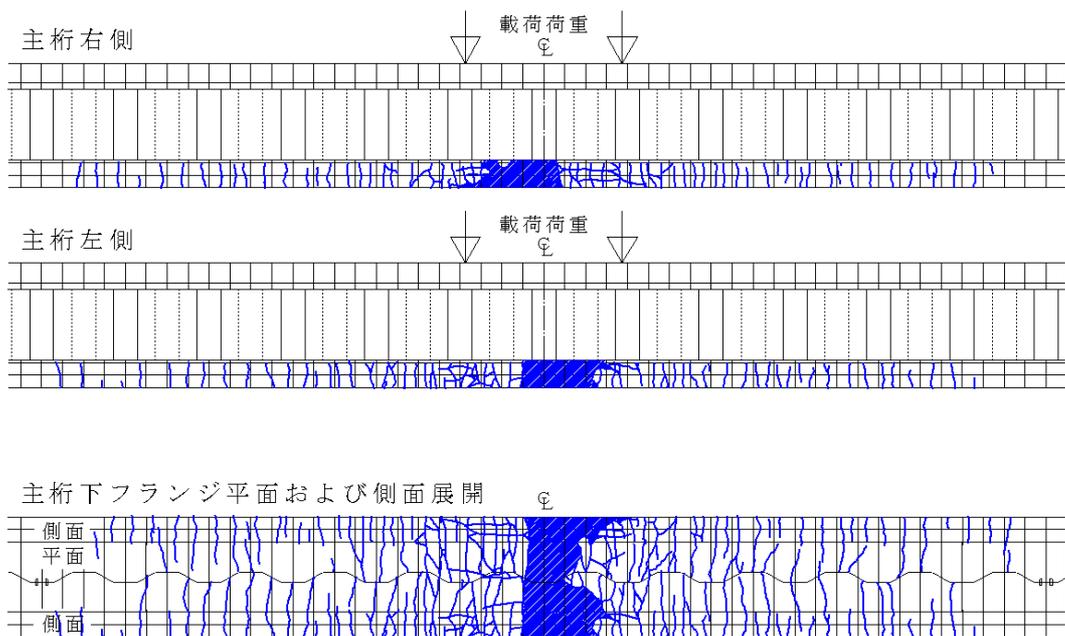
曲げ載荷試験後のひび割れスケッチ図
